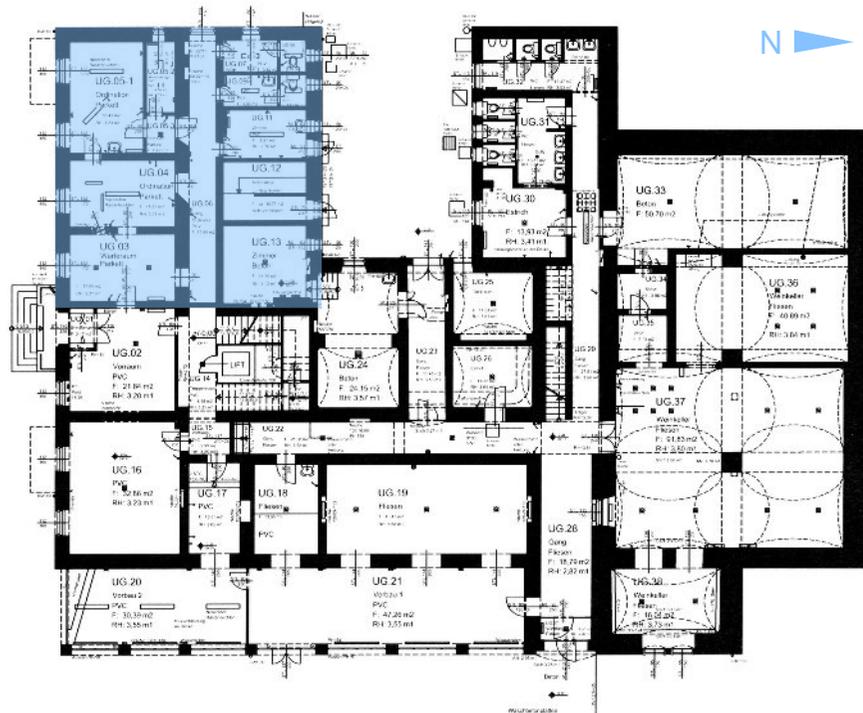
Grundriss mit Position der Ordination.
